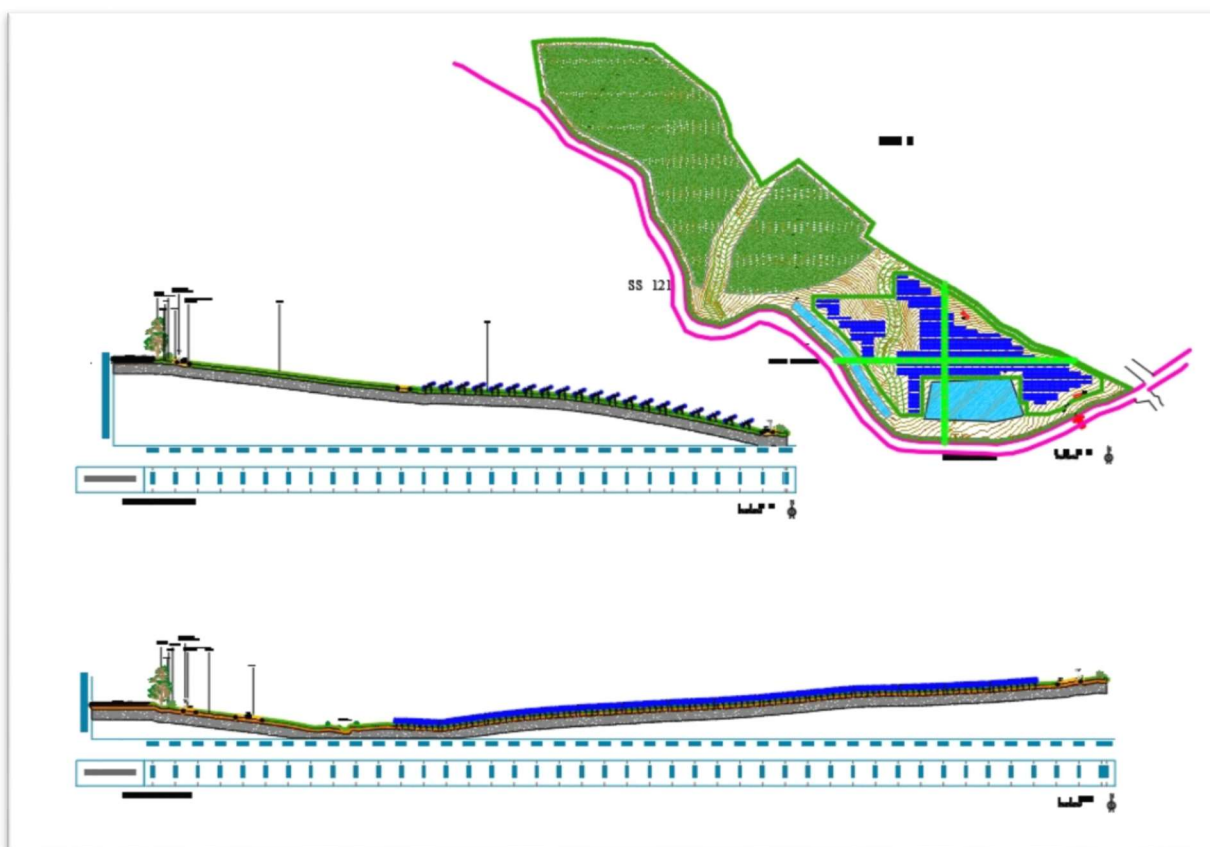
Area 1 Profili longitudinale e trasversale di progetto
